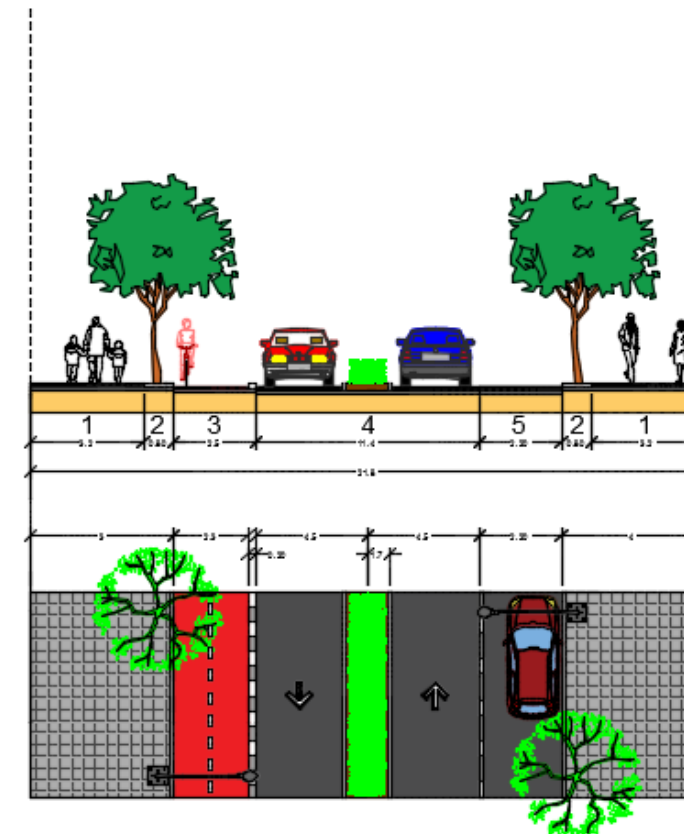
Avenida Arquitecto Alfredo Simón. Sección tras la actuación.
